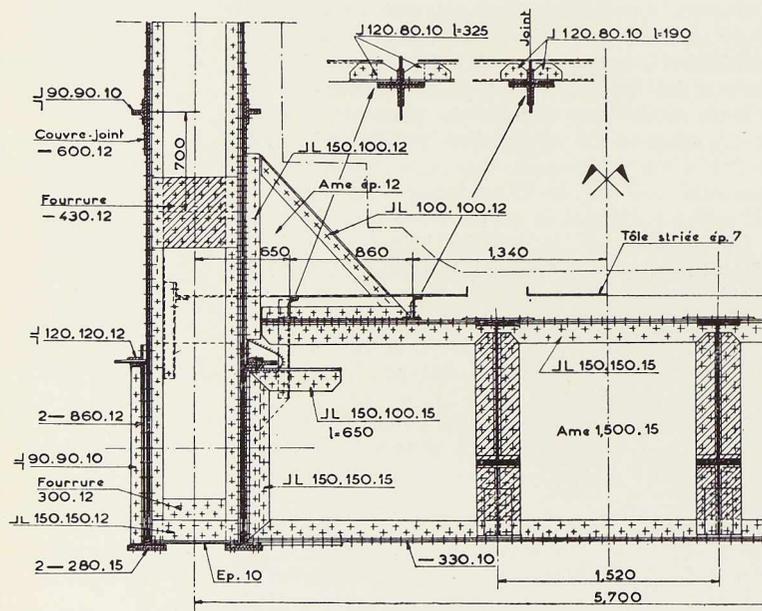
Assemblage d'une entretoise et d'une poutre principale de la travée médiane.
